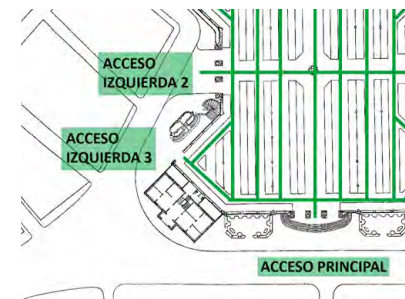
Plano detalle de la entrada ACCESO IZQUIERDA 3 por la calle Palafox
